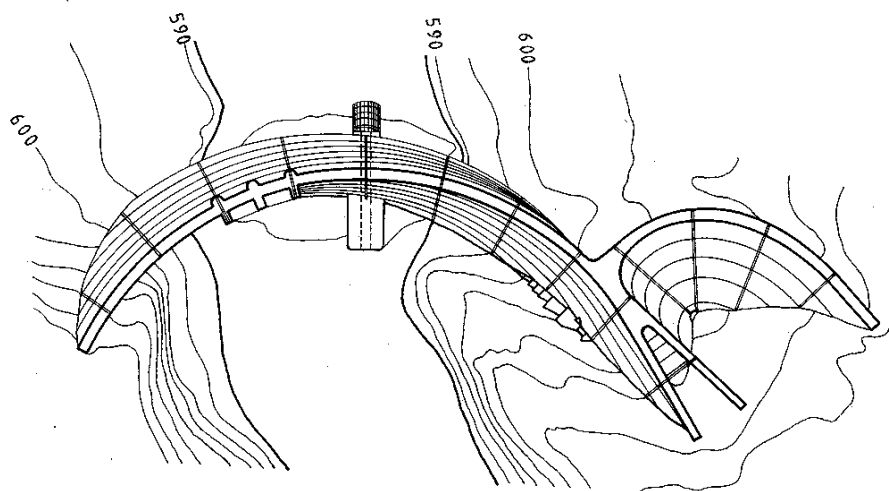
Barragem de Santa Luzia. Planta (fonte: www.inag.pt)
